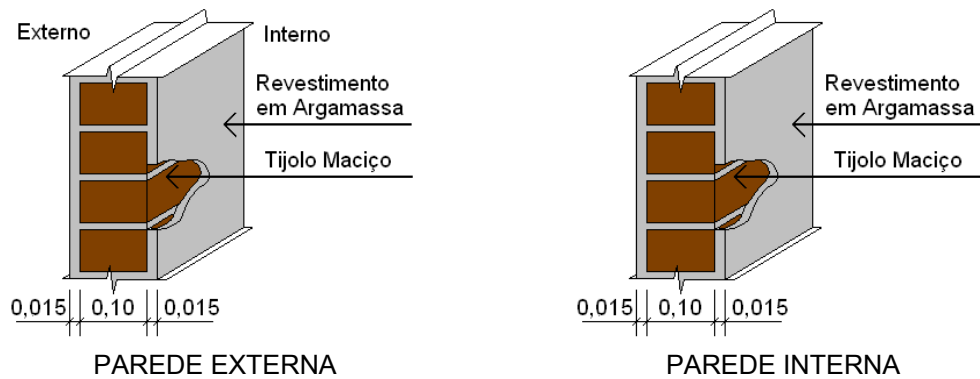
Detalhe construtivo das alvenarias externa e interna - Edificação 5.
